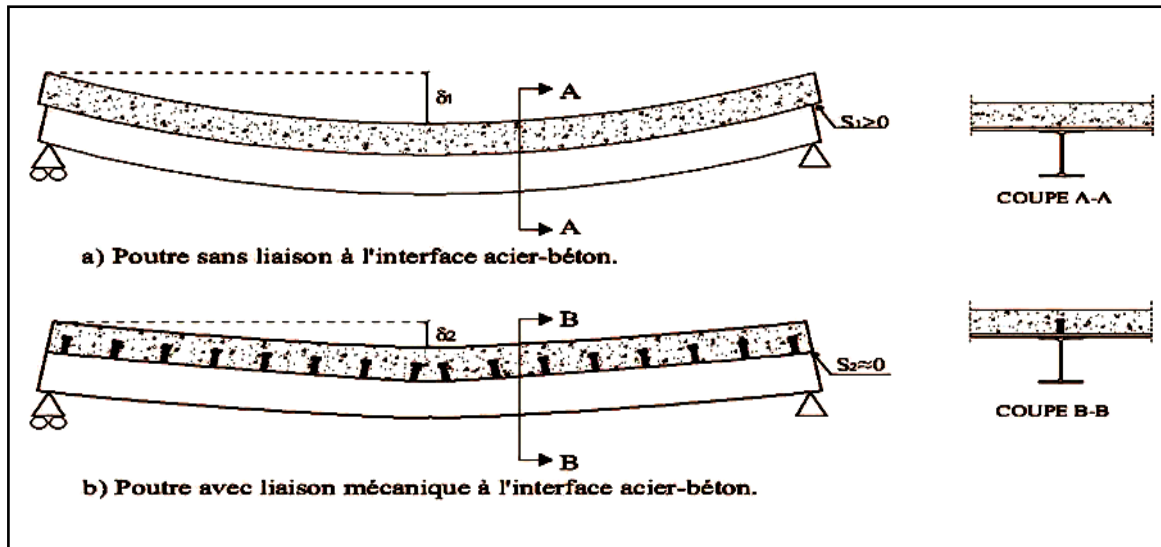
Principe de fonctionnement de poutre mixte fléchie.
